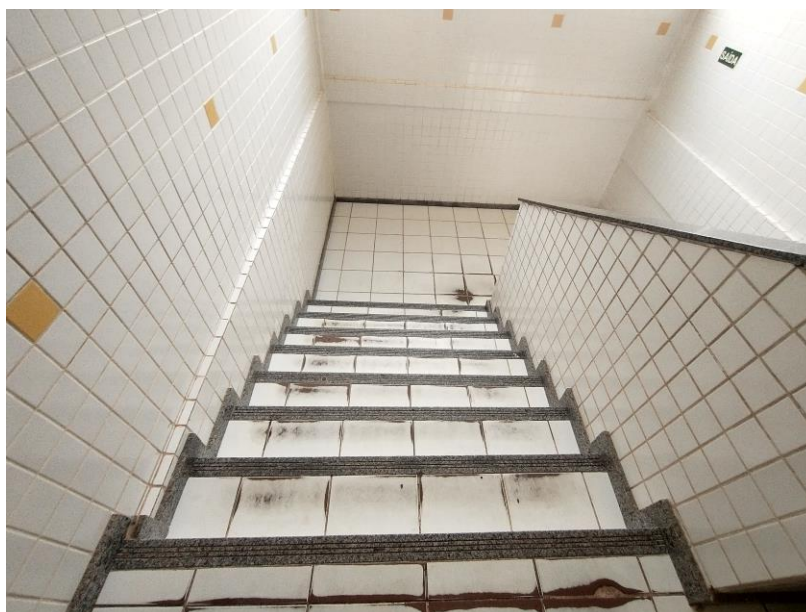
Vista da escada de acesso ao 1º pavimento.
